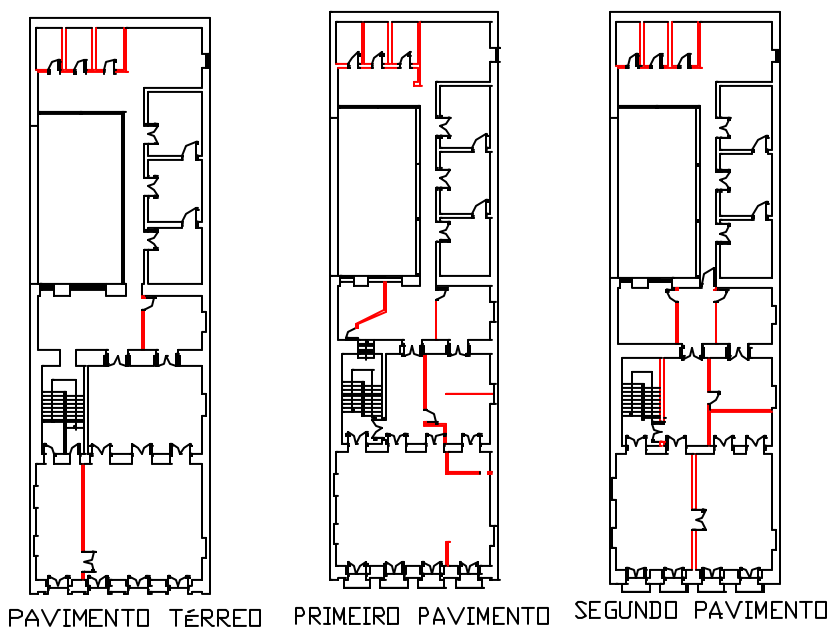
Plantas Baixas térreo, 1º e 2º pav.
